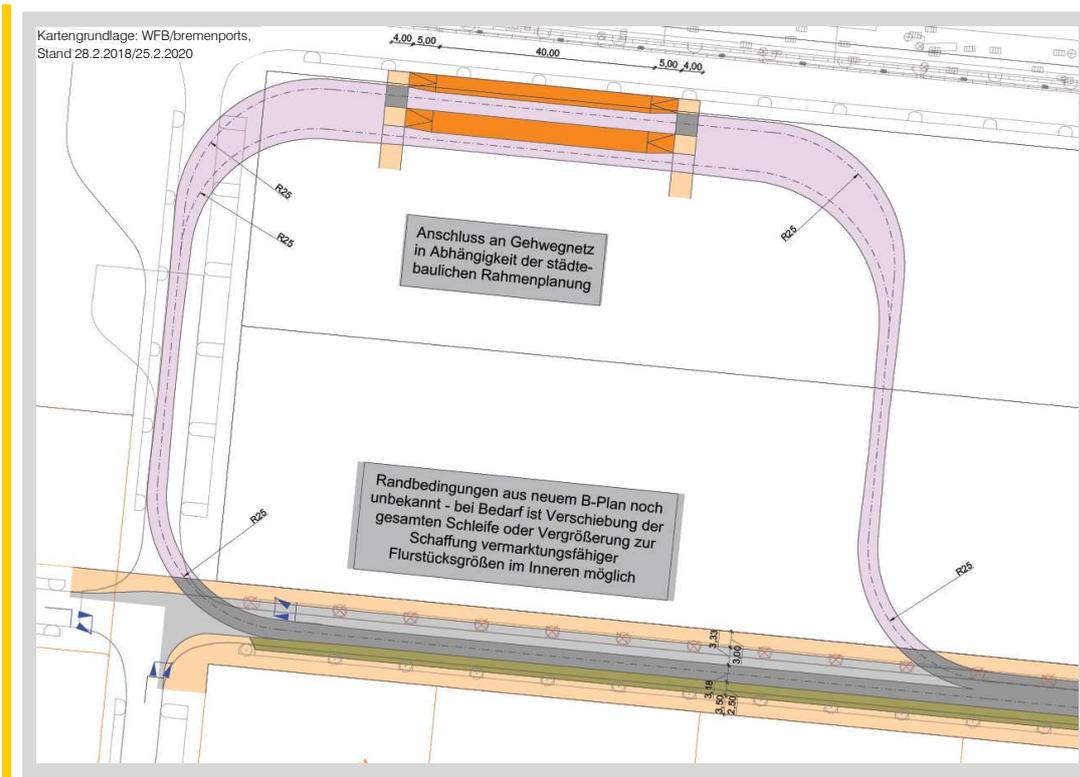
Ausschnitt Lageplan Blockumfahrung Überseehafen
